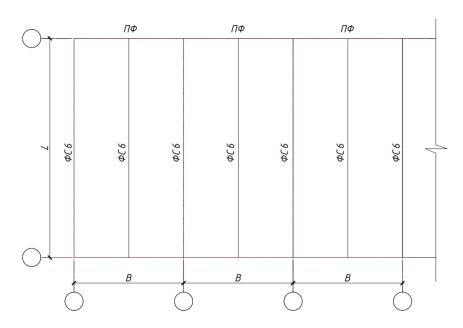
Вариант 2 — покрытие с подстропильными фермами
